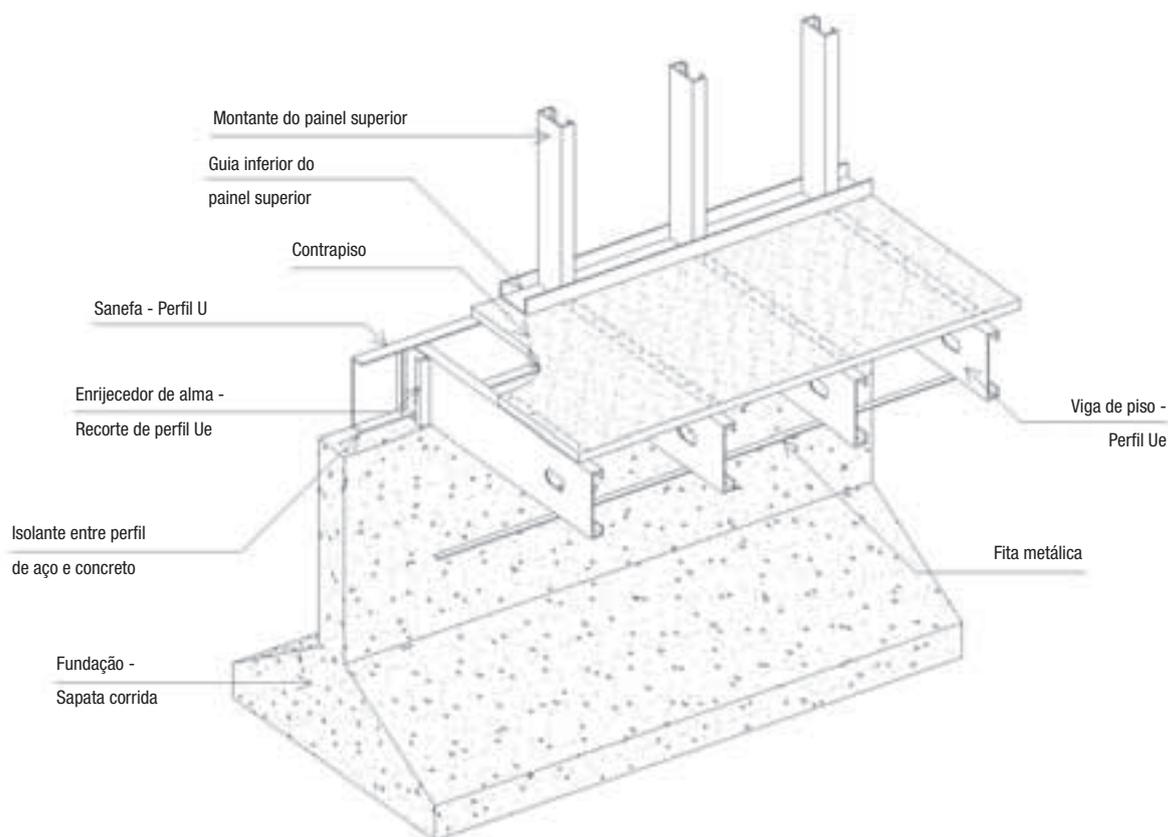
Laje em Light Steel Framing apoiada sobre fundação tipo sapata corrida
